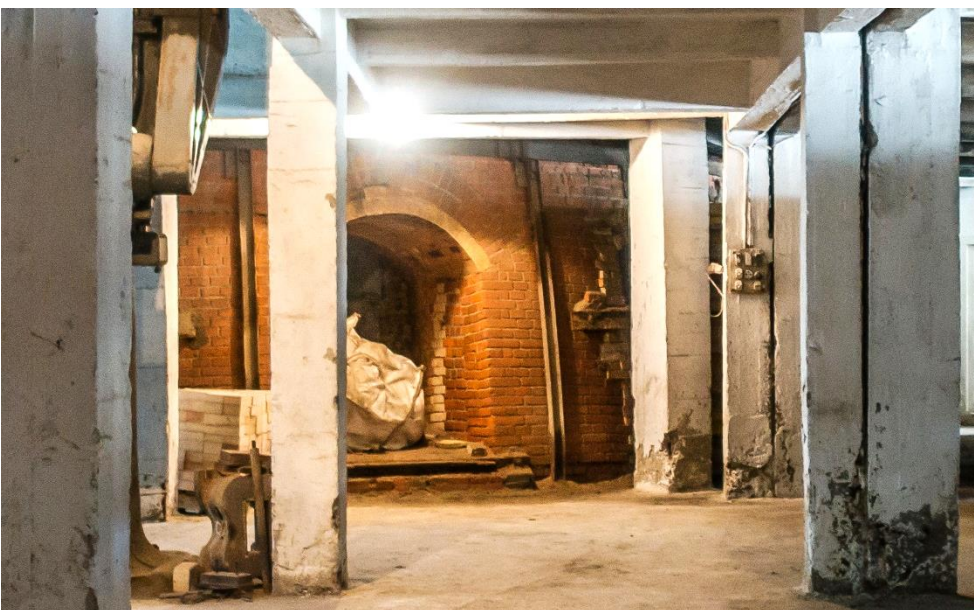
Imagen del horno 4 en planta baja. (Ana Vitoria)
